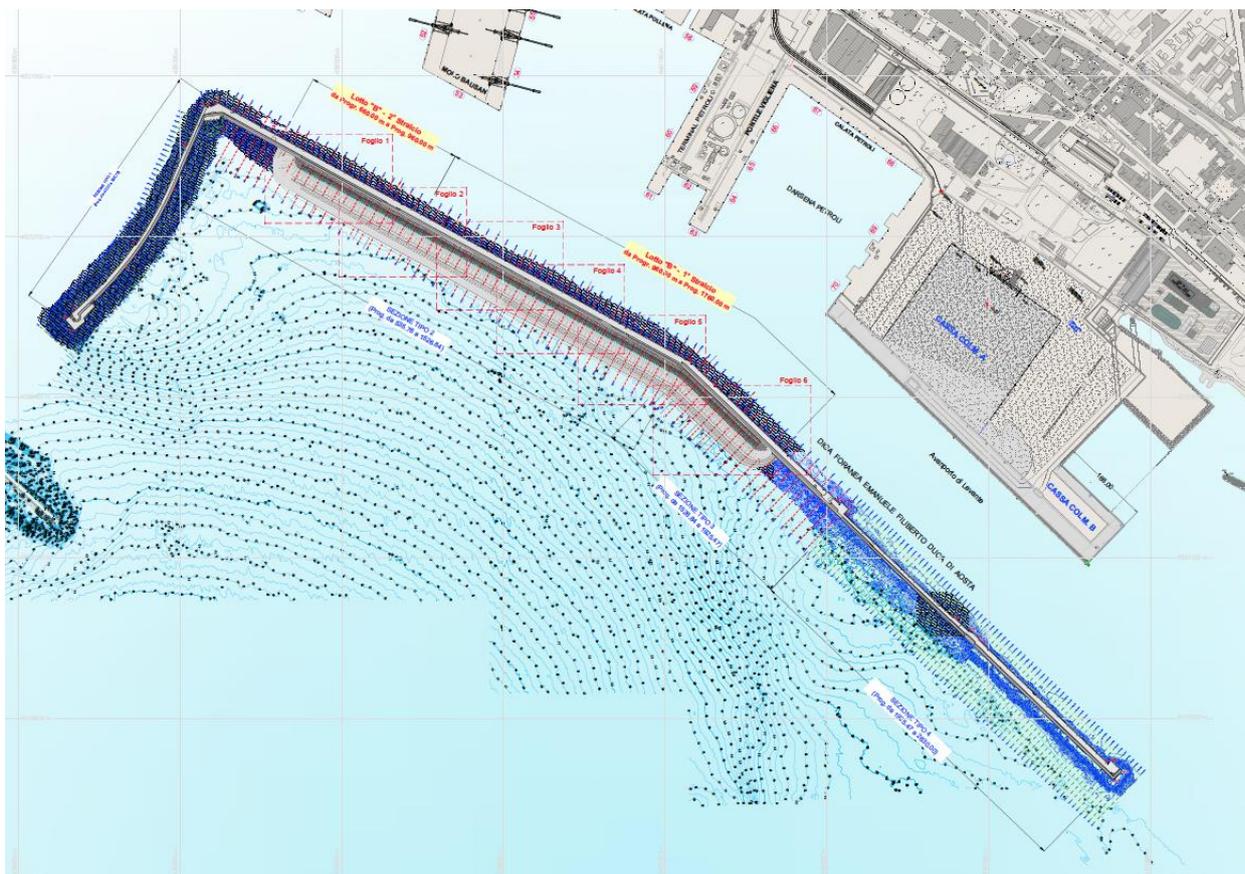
Planimetria di progetto opere I stralcio 800 m (PNRR) – opere di II stralcio 300 m (completamento)
